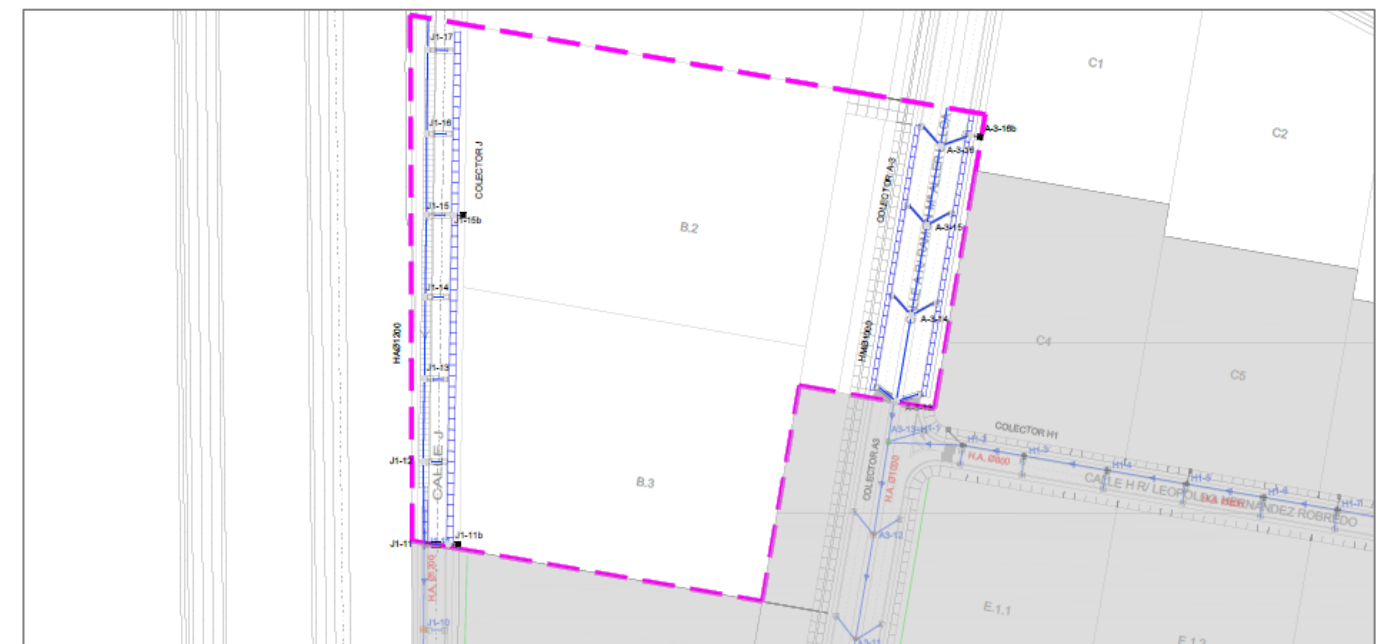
Trazado de la red de saneamiento pluvial de la Fase VIIa
